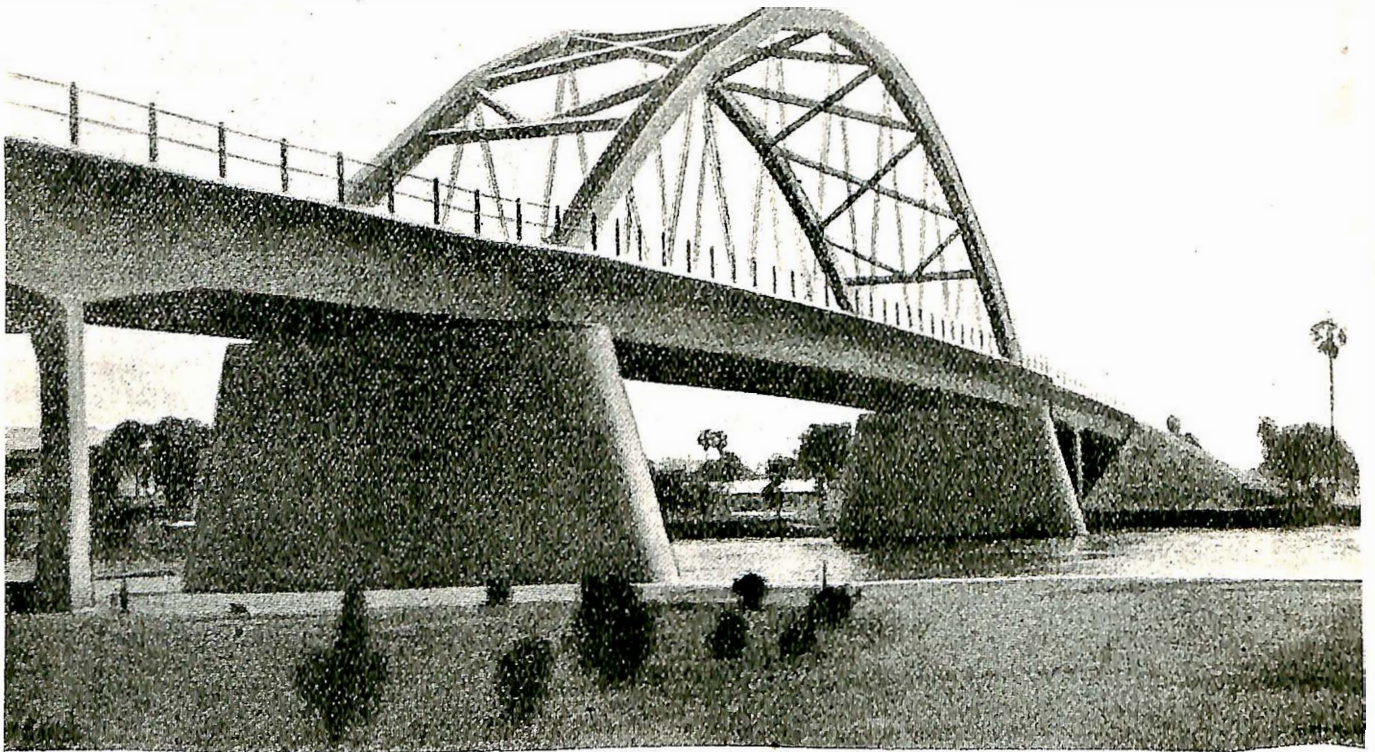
Armert betongvegbru over Maenam Pasak ved Ayuthia i Siam.
